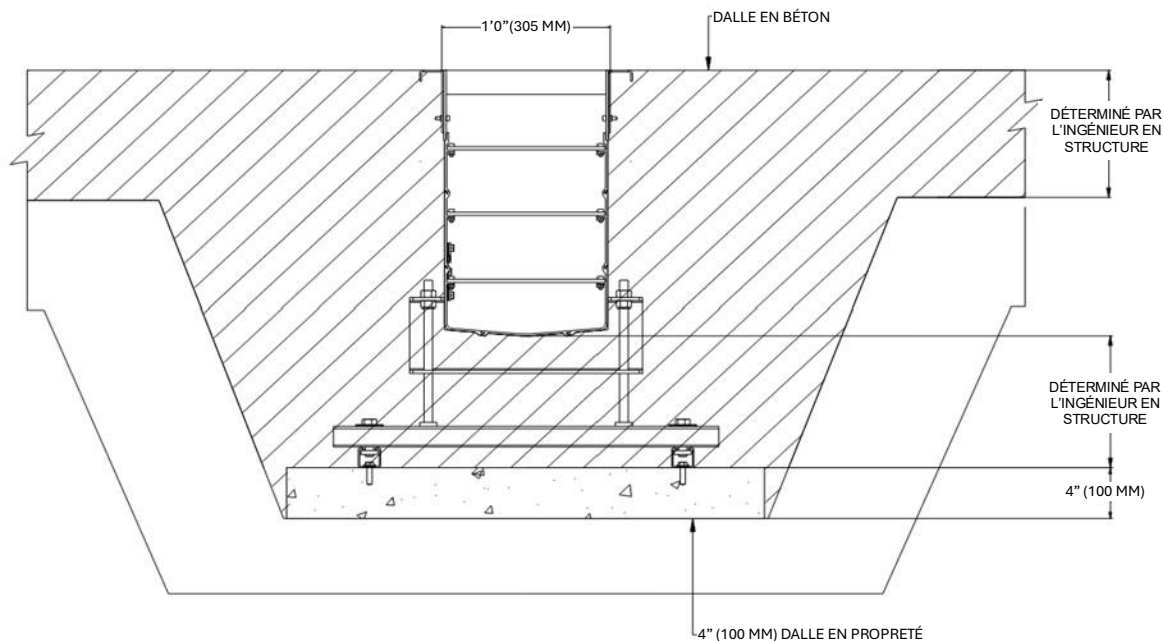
Conception de dalle avec caniveaux préfabriqués en aluminium
